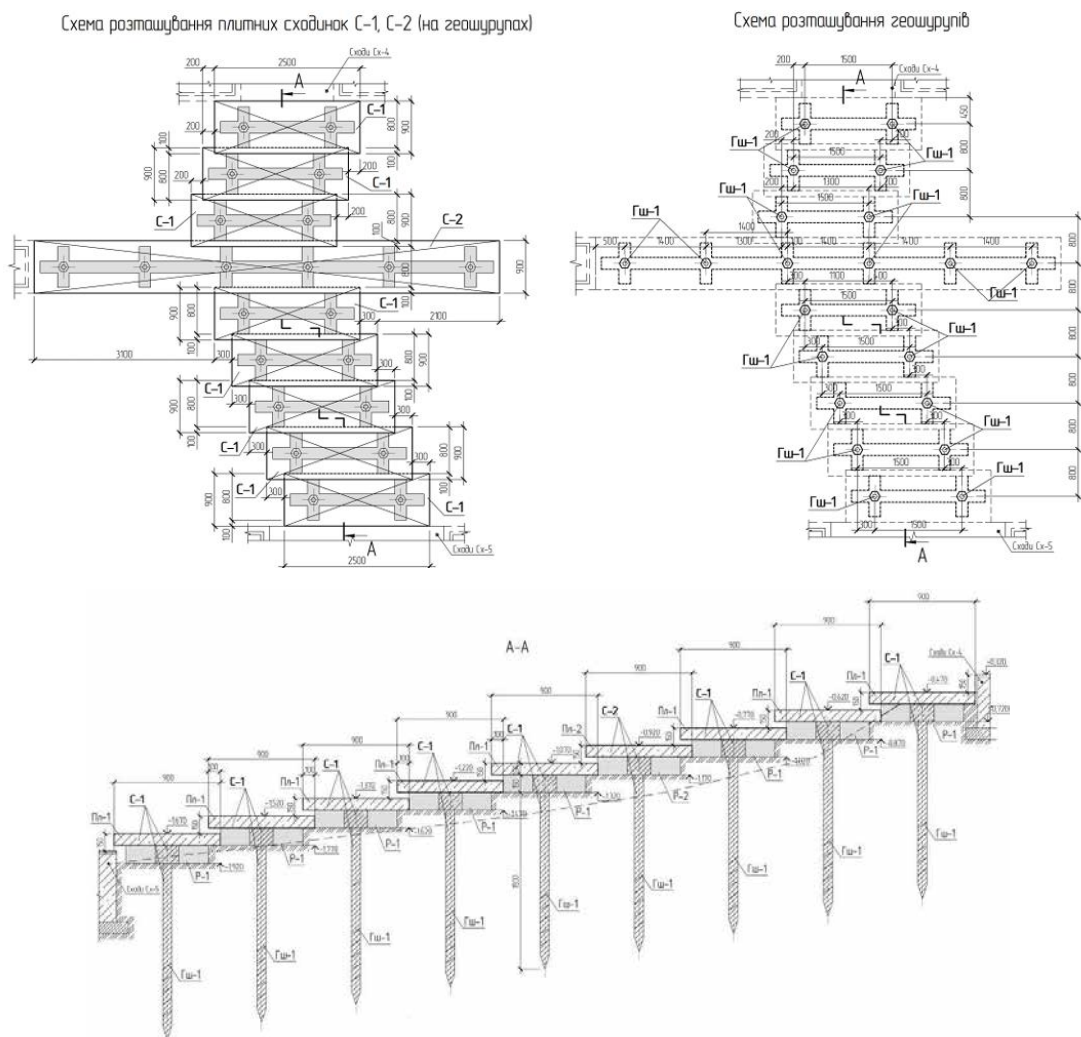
План і розріз сходів у вхідній зоні (розроблено автором)
